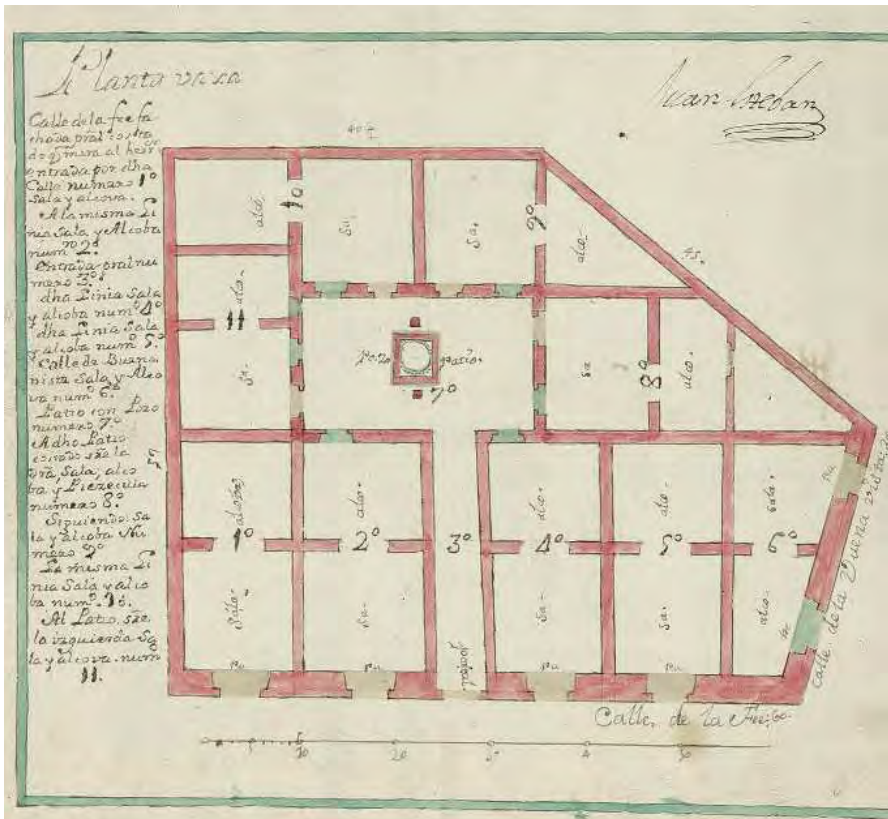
Planta de la casa construida en c/ Buenavista. (1751-AVM: 1-84-146).
